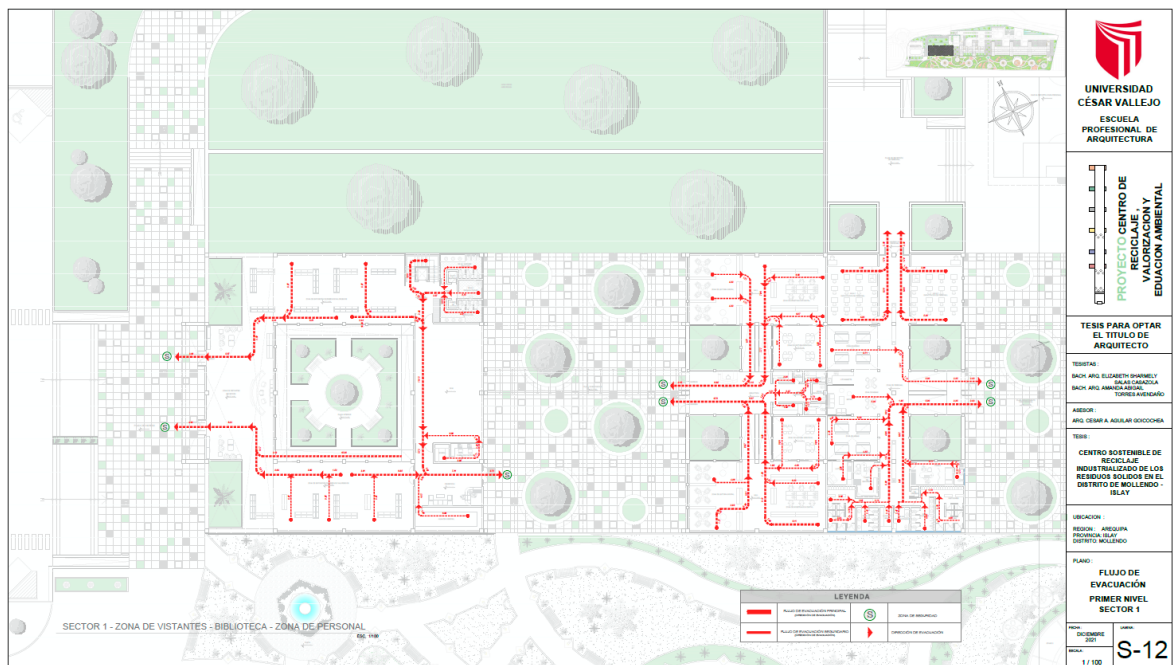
Plano de Evacuación, Sector 1 – Primer Nivel
